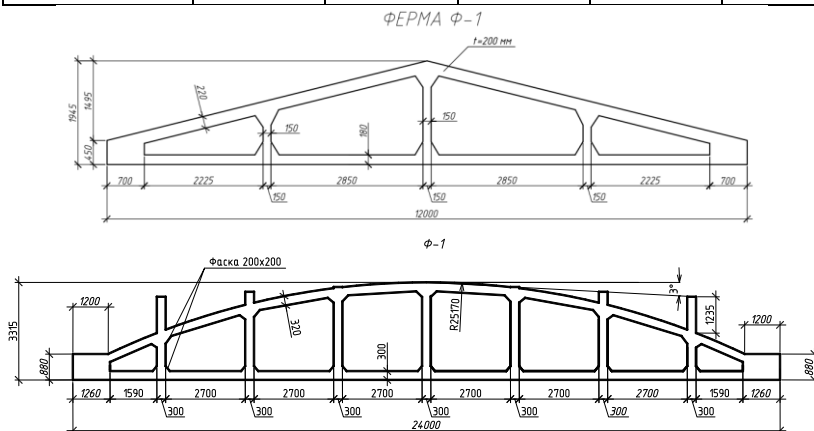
Кроквяні залізобетонні ферми промислової будівлі
